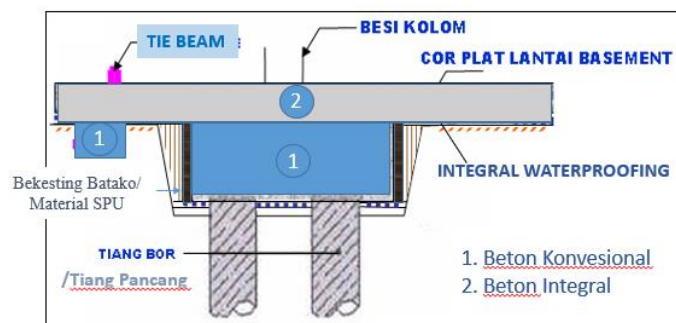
Detail Potongan Melintang Pile Cap, Tie Beam, dan slab
